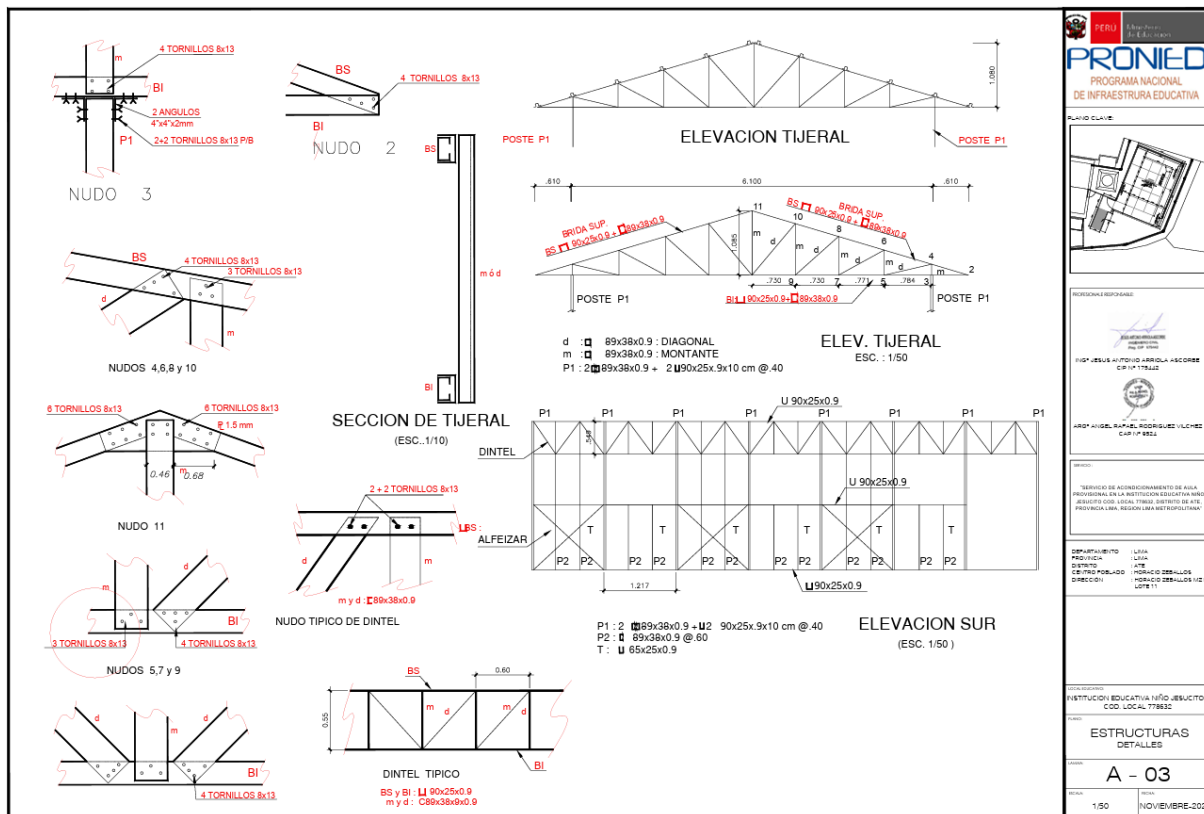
Plano de propuesta de intervención con aula provisional: Estructuras de soporte de acero galvanizado.
